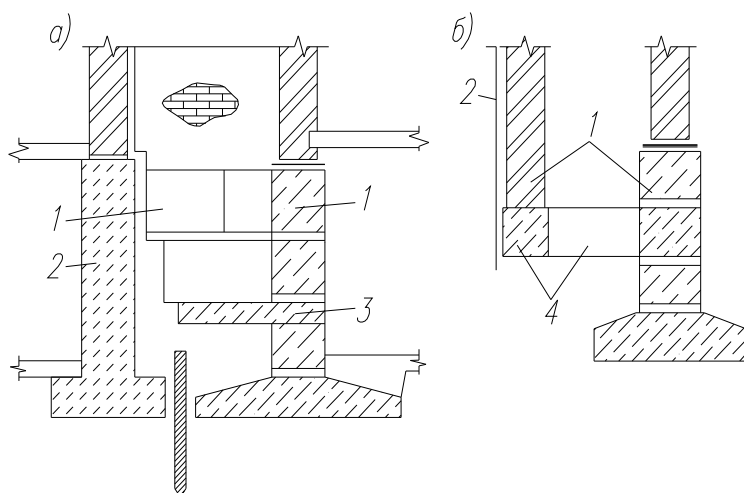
Использование консольных железобетонных балок (а) и плит (б) при устройстве фундаментов пристраиваемой части
